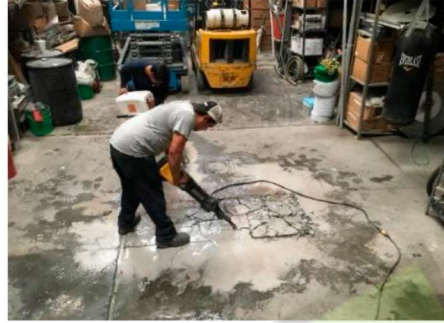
RETIRO Y DEMOLICIÓN DE PISO DE CONCRETO VIEJO
